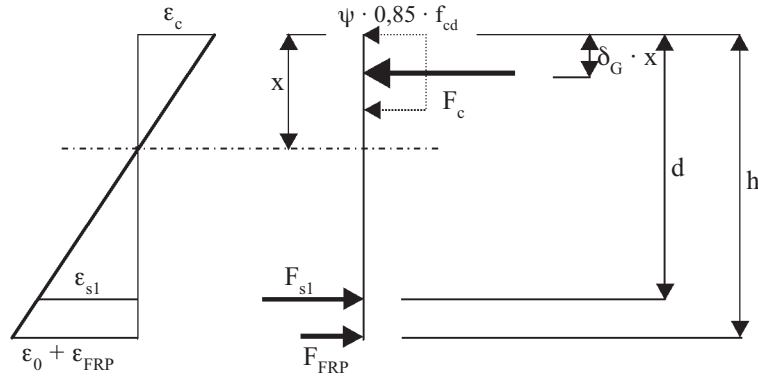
Cálculo de la sección transversal de la viga reforzada para el ELU.
